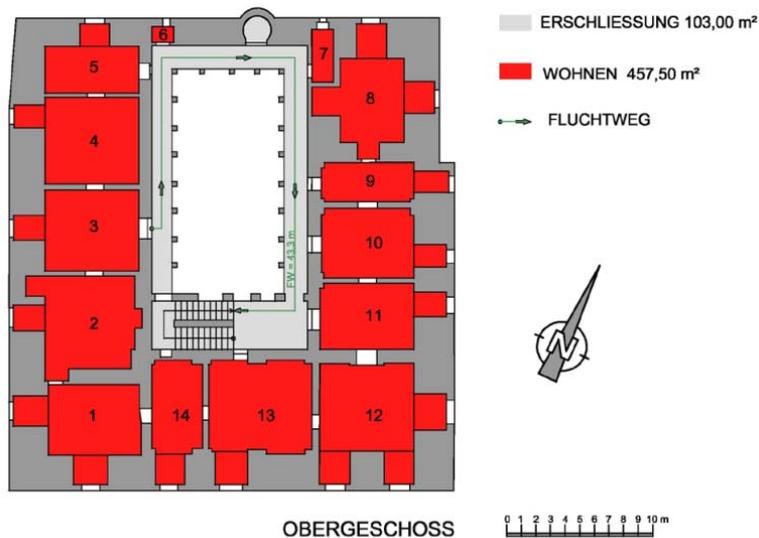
zeigt den Grundriss des Schlosses Bockfließ
